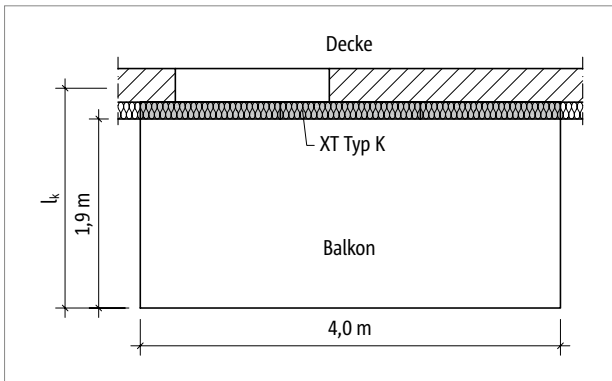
Schöck Isokorb® XT Typ KL: Grundriss
